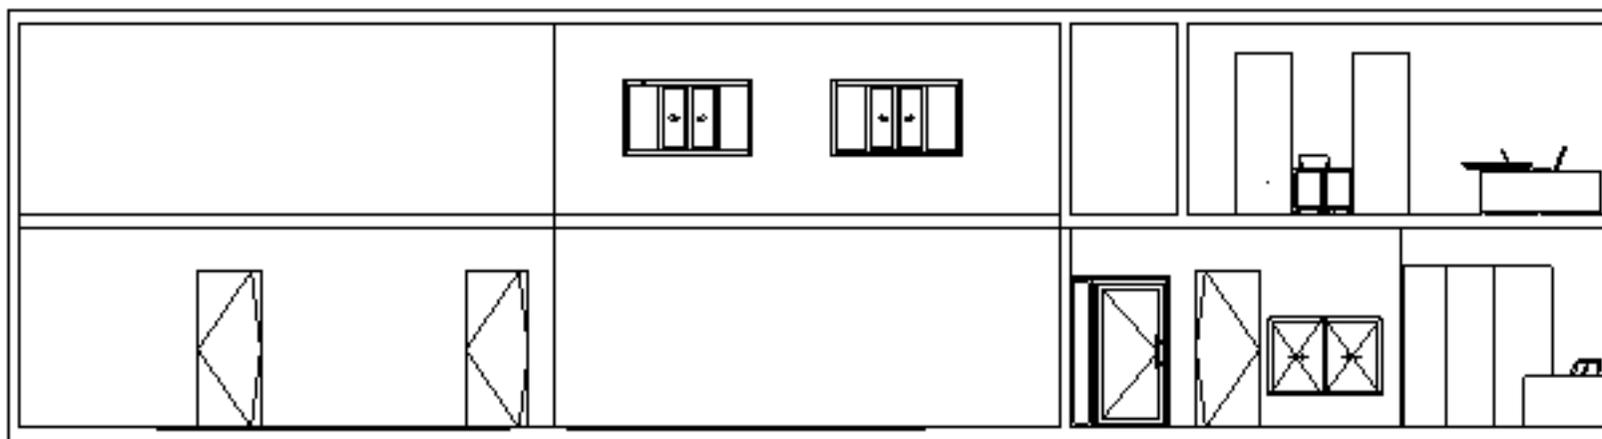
Corte BB – Entrada do Laboratório de Análise Estrutural e de Materiais
